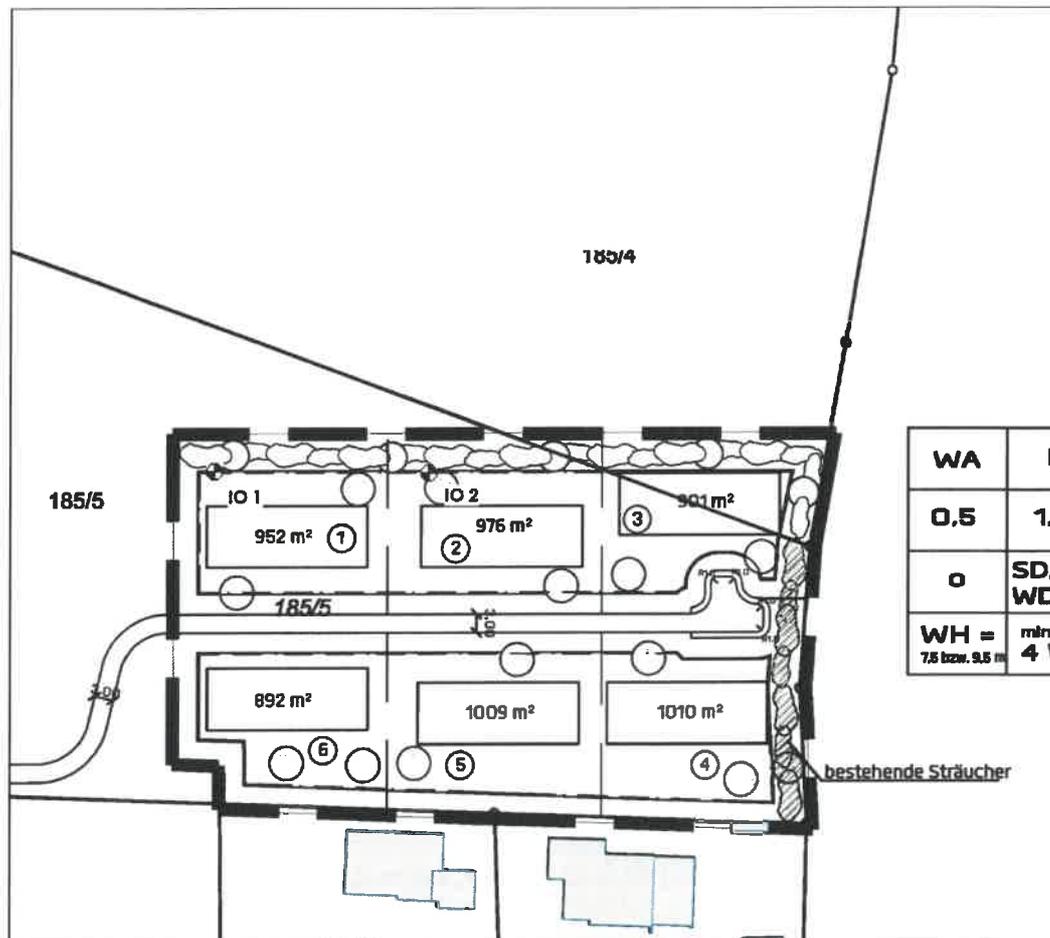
Lageplan mit Darstellung der exemplarischen Immissionsorte
